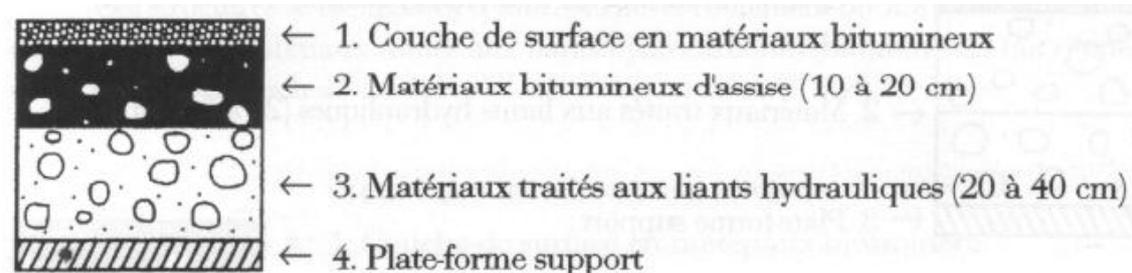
Chaussée à structure mixte [catalogue des chaussées, 1998]
